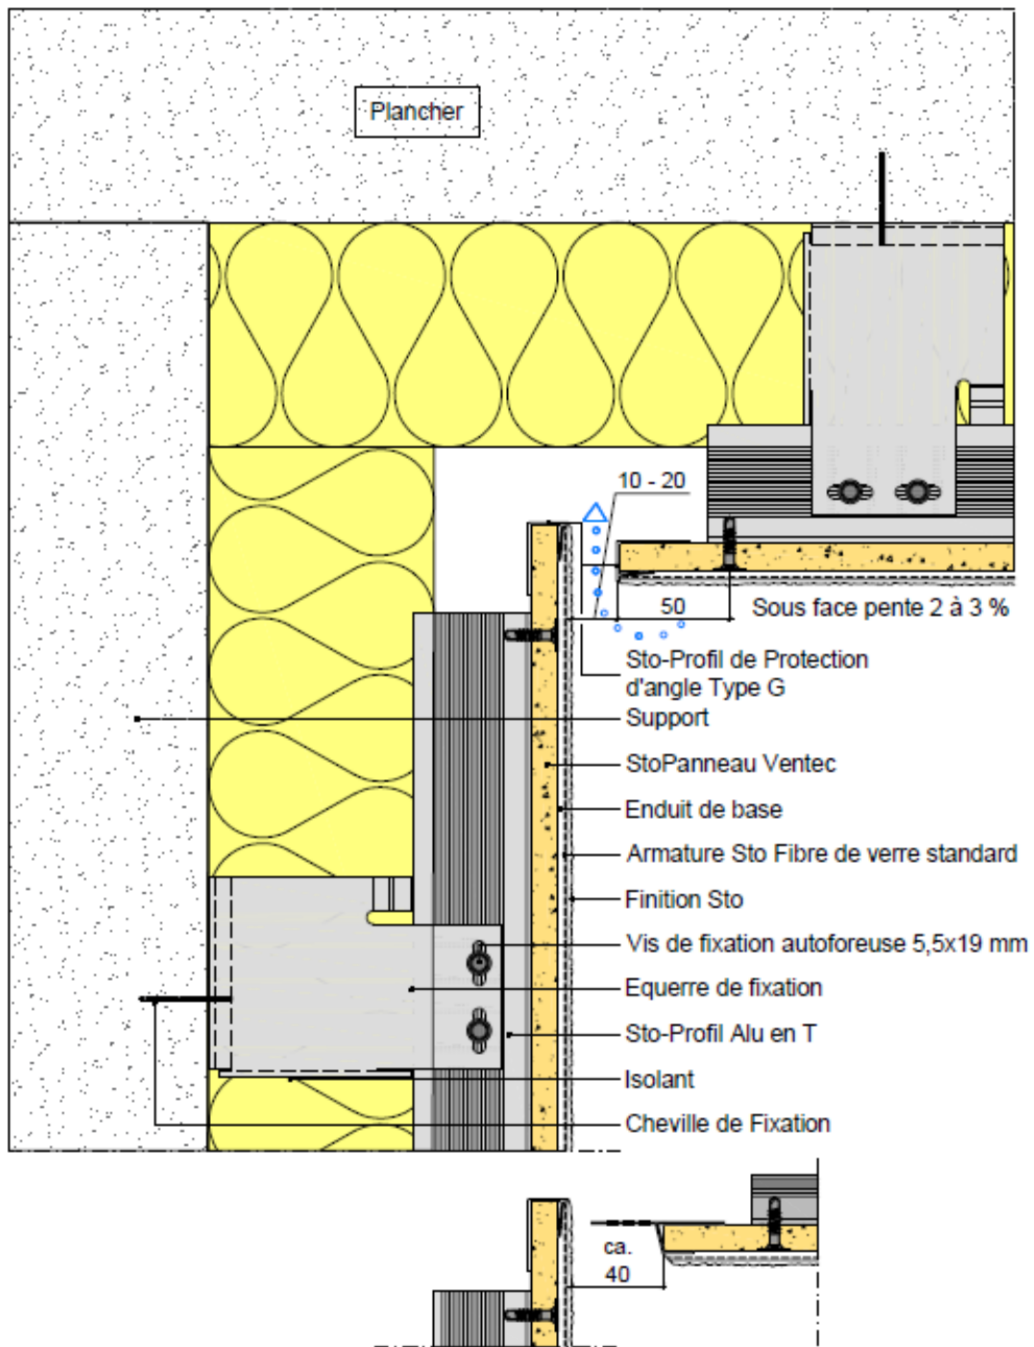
Coupe verticale - Pose en sous-face - Interface entre la sous-face et le bardage en retrait de la façade - Ossatures aluminium sur support béton
